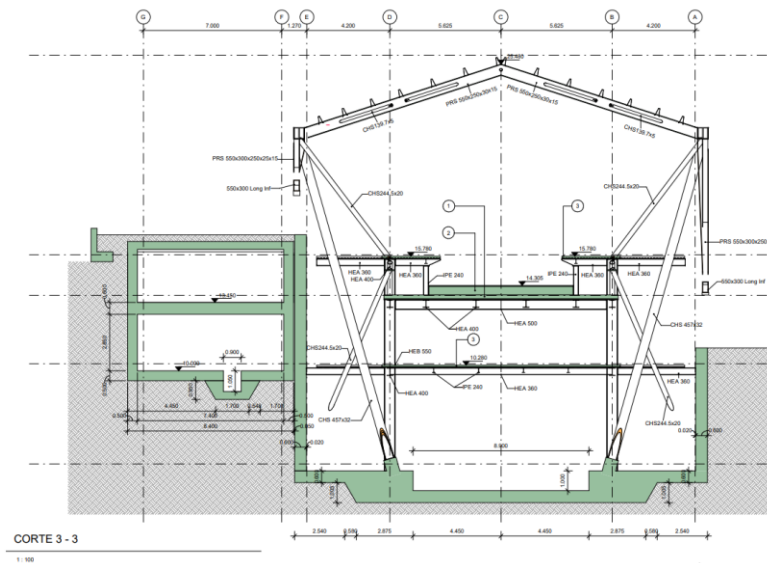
Secção transversal tipo da estrutura da estação –zona com pilares
